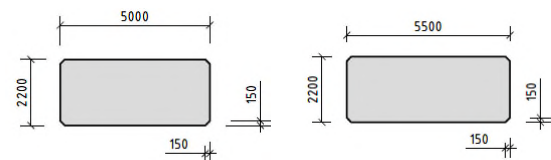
Sección transversal de las pilas para la E62 (izquierda) y E63 (derecha).
